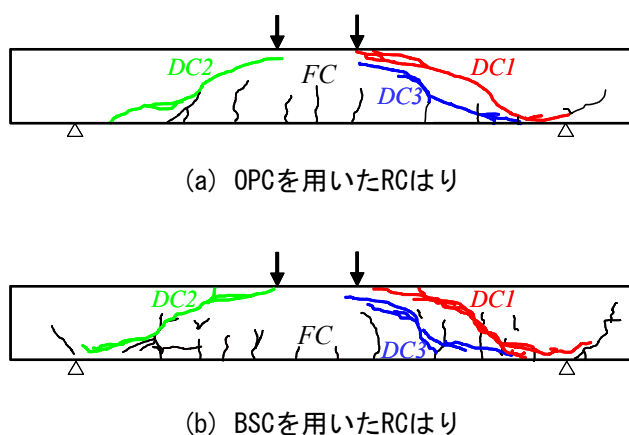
RCはりのひび割れ発生状況(載荷試験後)
